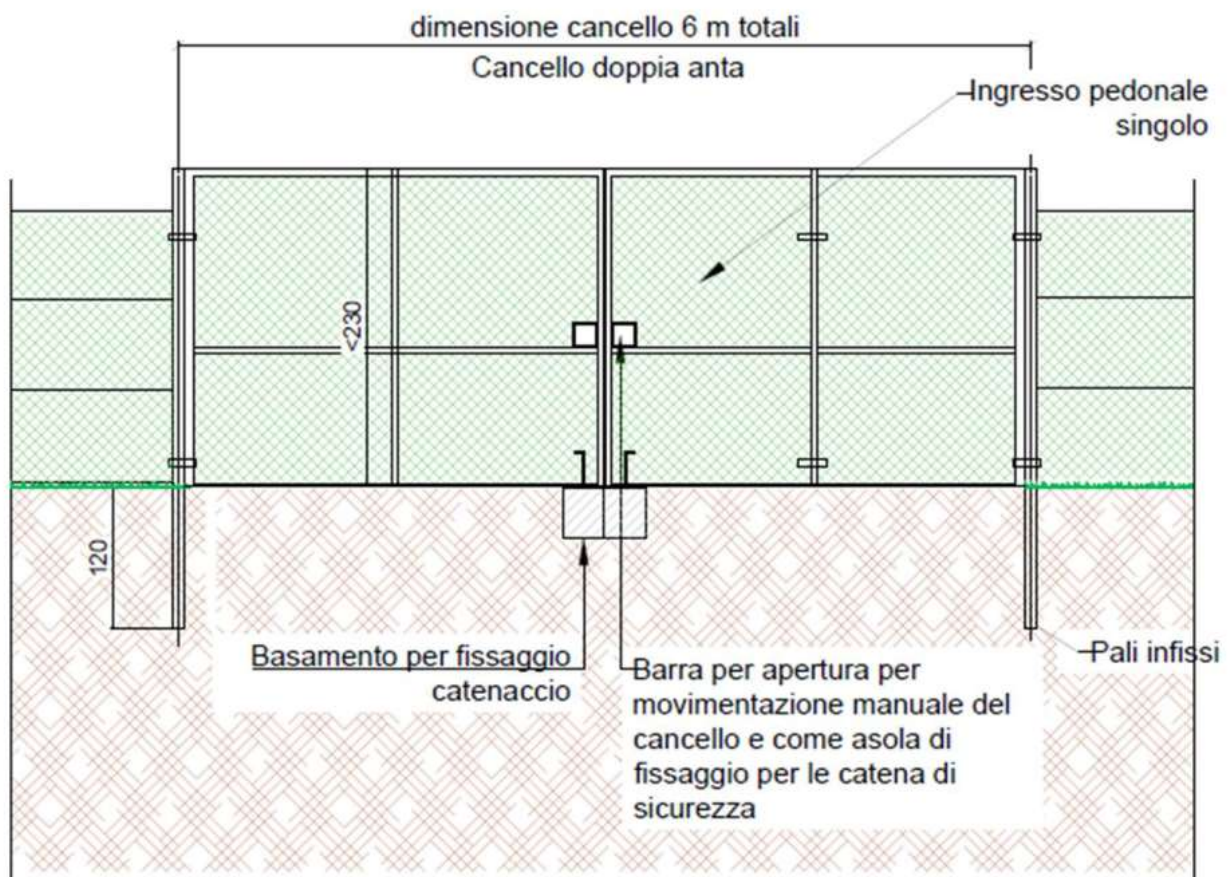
Dettaglio di insieme dei cancelli di accesso alle aree di impianto.
